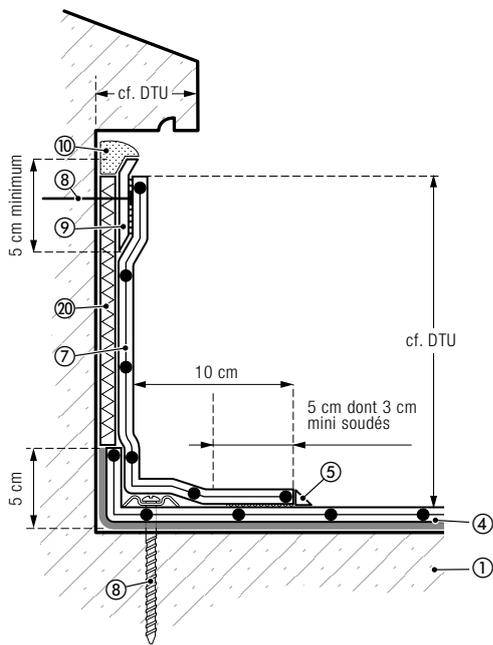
Relevé d'étanchéité libre de hauteur < 200 mm avec pare-vapeur bitumineux sur maçonnerie
